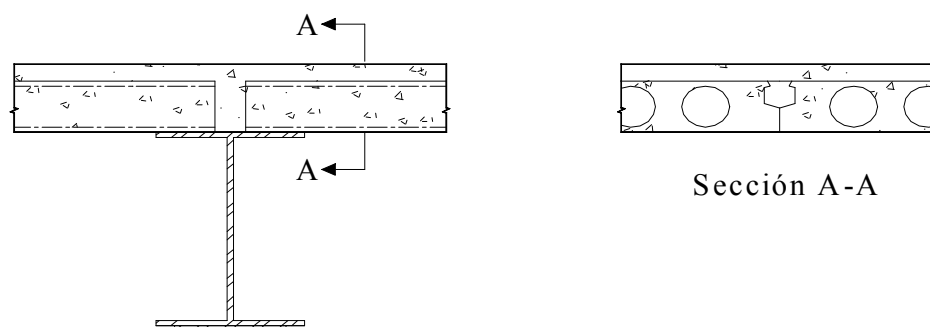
LOSAS DE CONCRETO PREFABRICADAS SOBRE VIGAS DE ACERO
